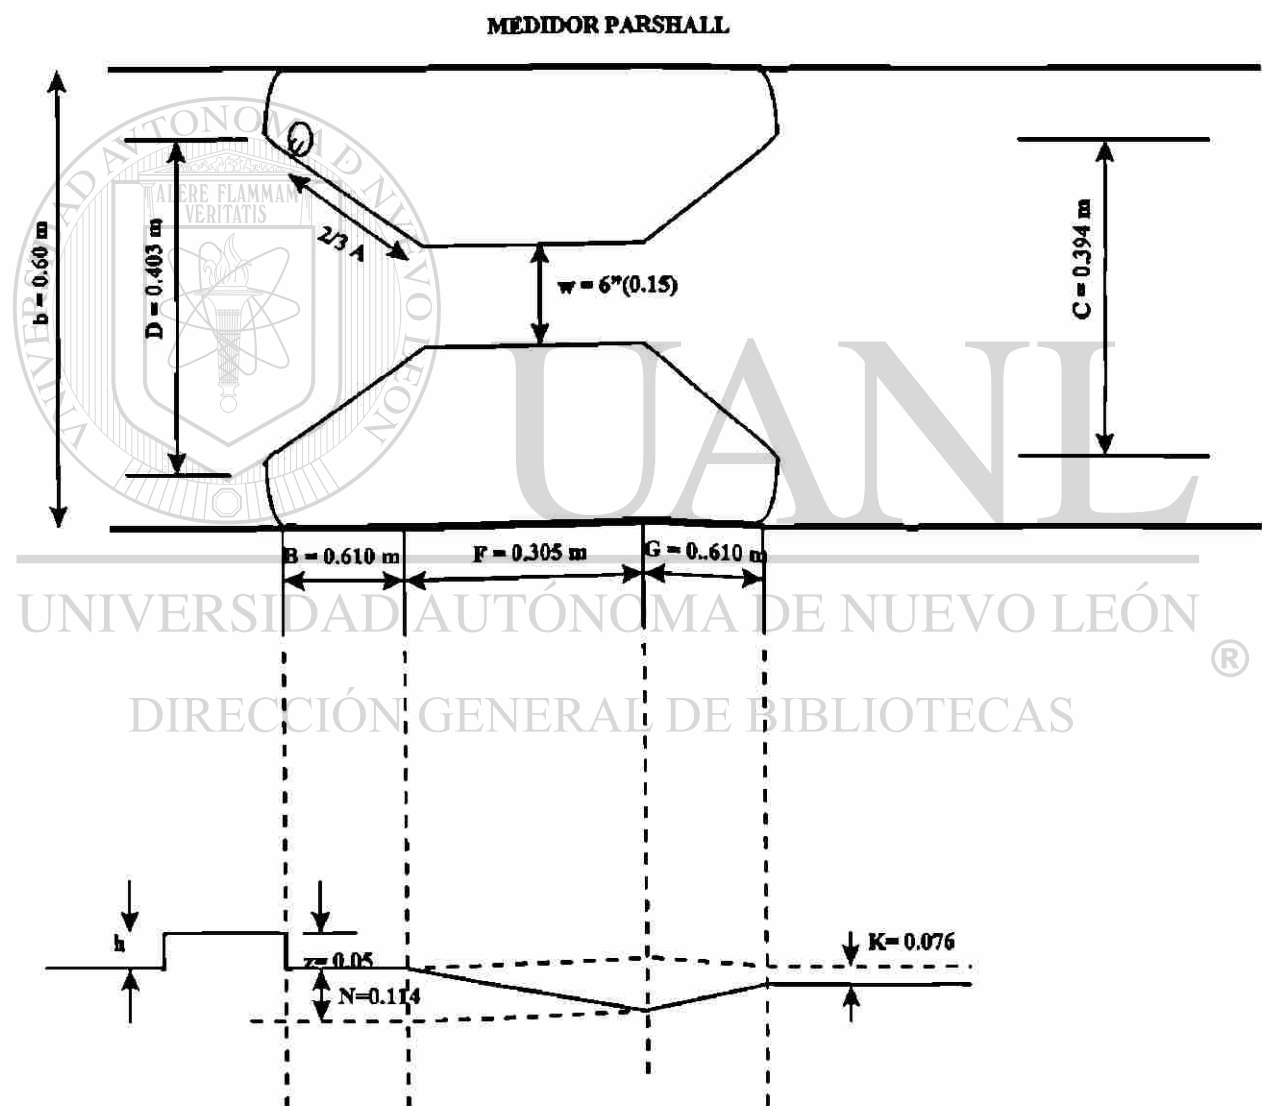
Planta y Elevación del Medidor Parshall, dimensionadas.
